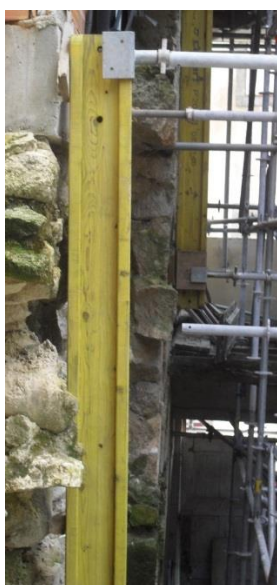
Parede exterior de alvenaria de tijolo no último piso
